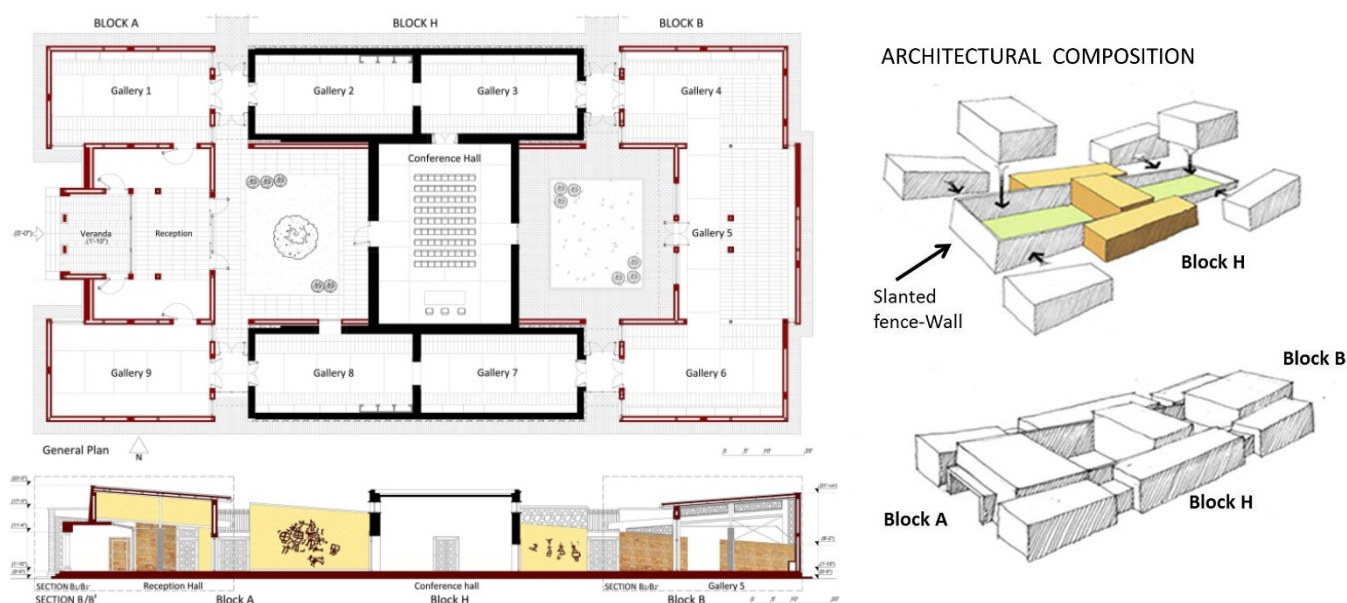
Pianta, sezione longitudinale, schizzo 3D
